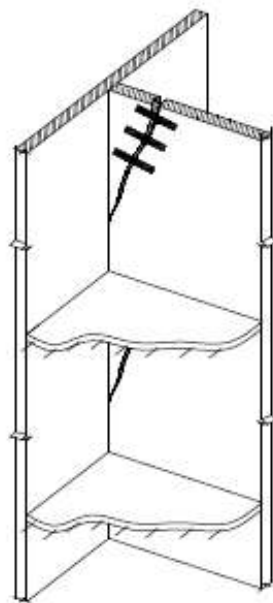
Схема усиления кладки стены с наклонной трещиной
